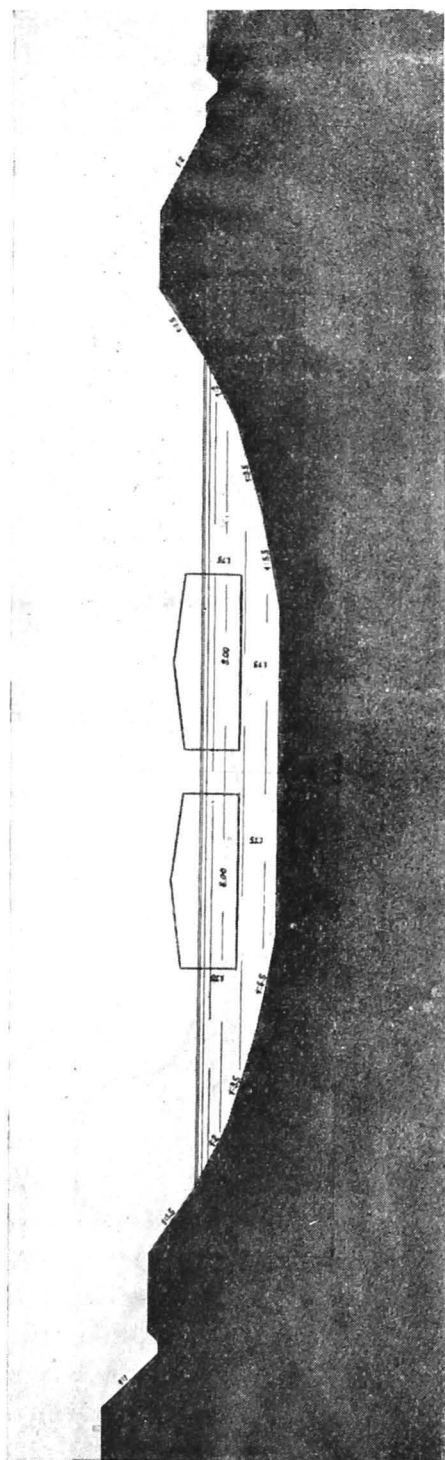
Profilul transversal al canalului Tei-Fundeni.
